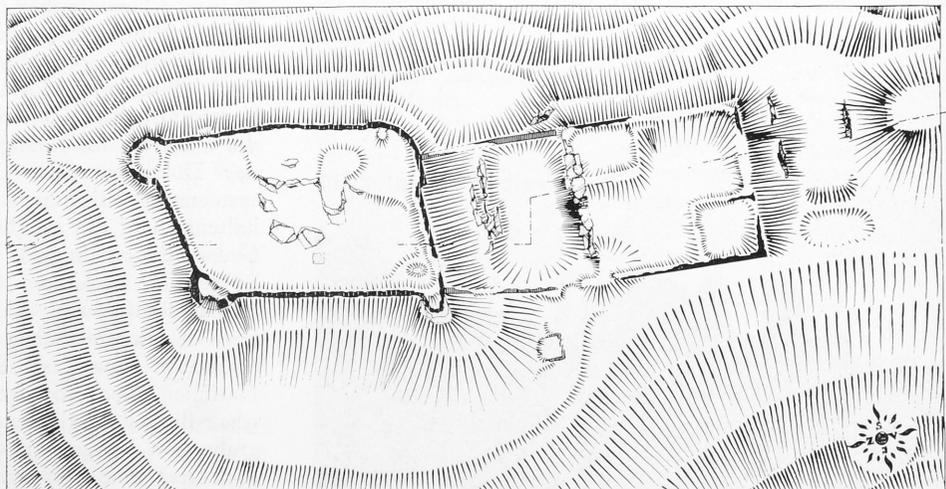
Burgruine Gerlachstein (Kolovec), Lageplan
